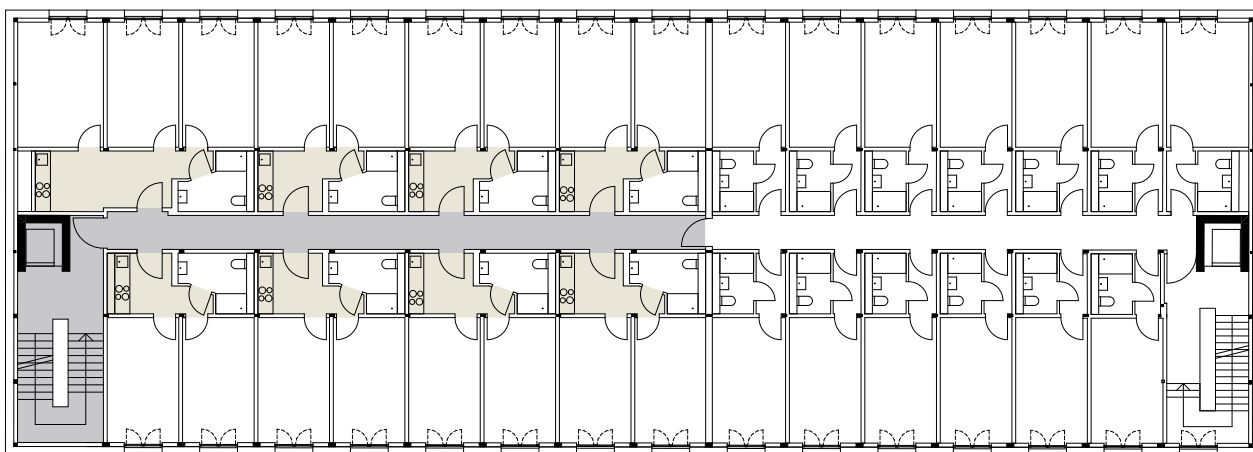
Grundriss Regelgeschoss, links das Auszubildendenwohnheim mit der Vario-Förderung und rechts das Gästehaus, M. 1:300 [© BF Vario]
